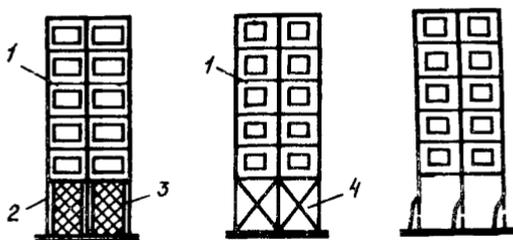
Здания с выключающимися связями в нижних каркасных этажах
